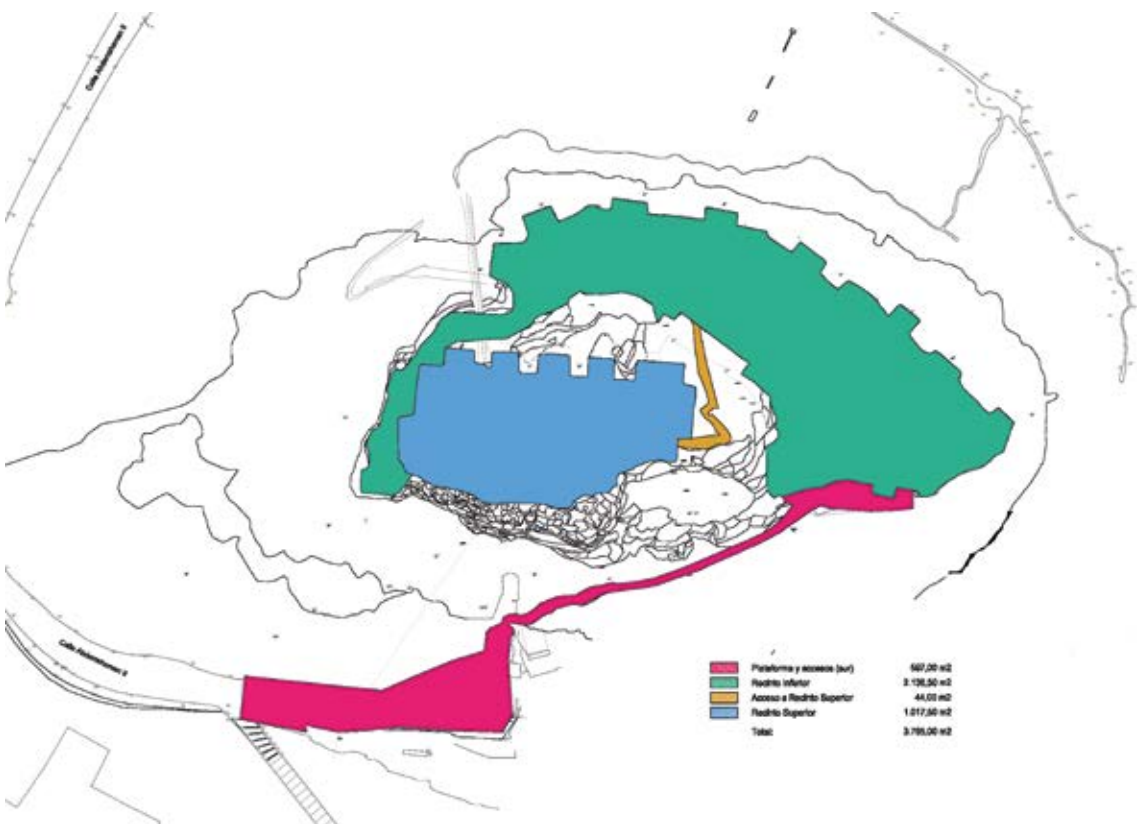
Planta de intervención: accesos, recintos inferior y superior. (Fuente: Proyecto fase A)
